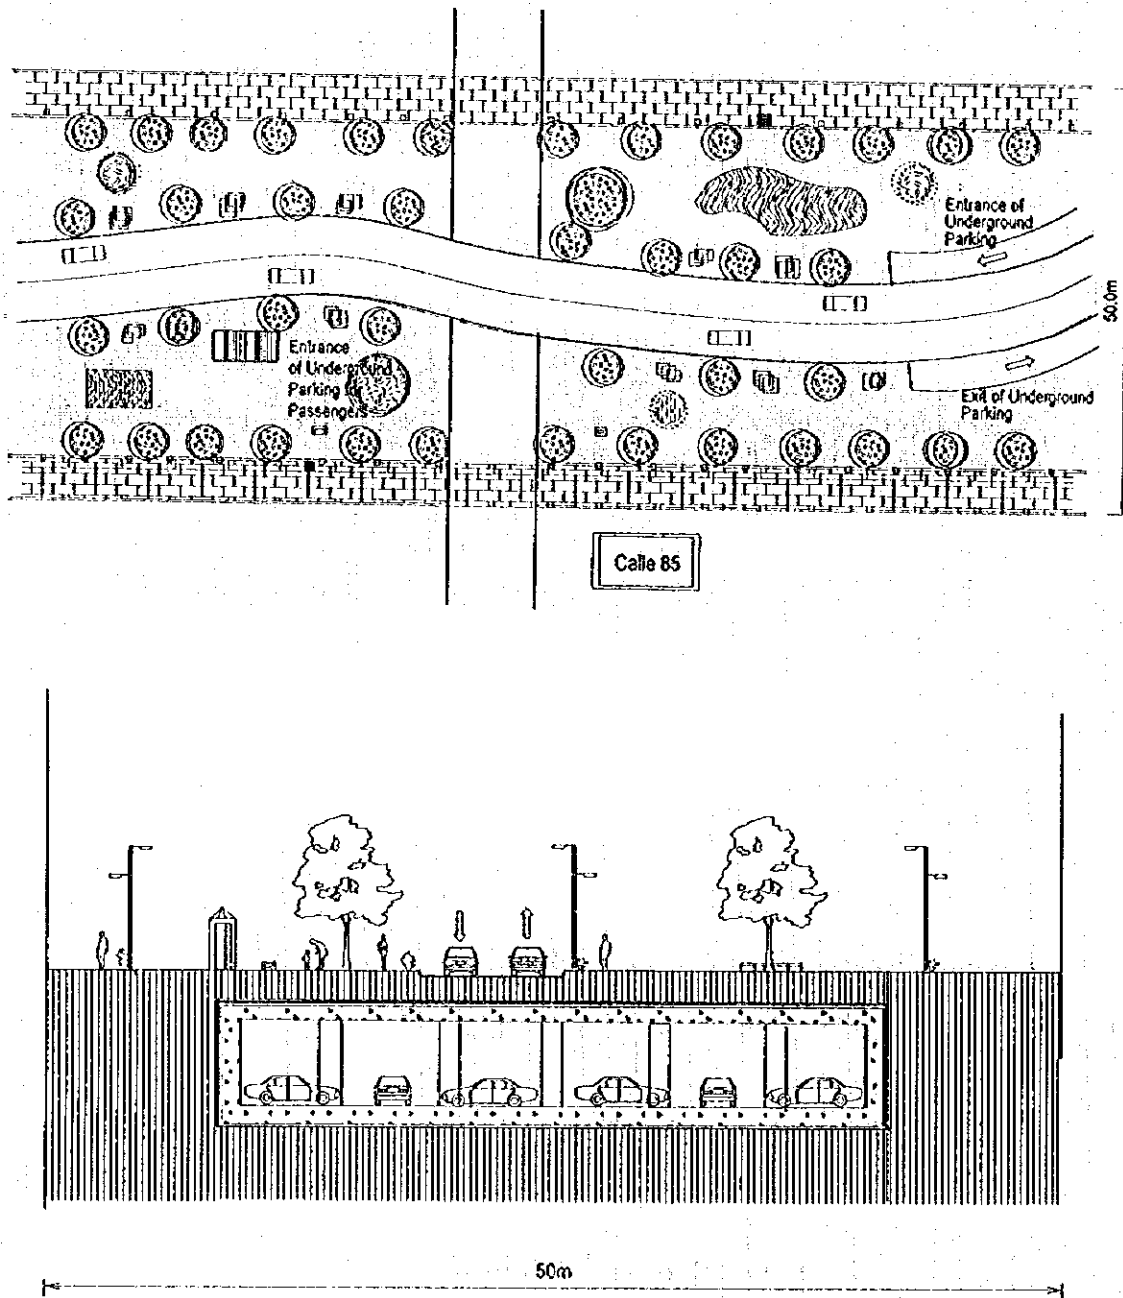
Corte Horizontal y Transversal Típico (Calle 85)
